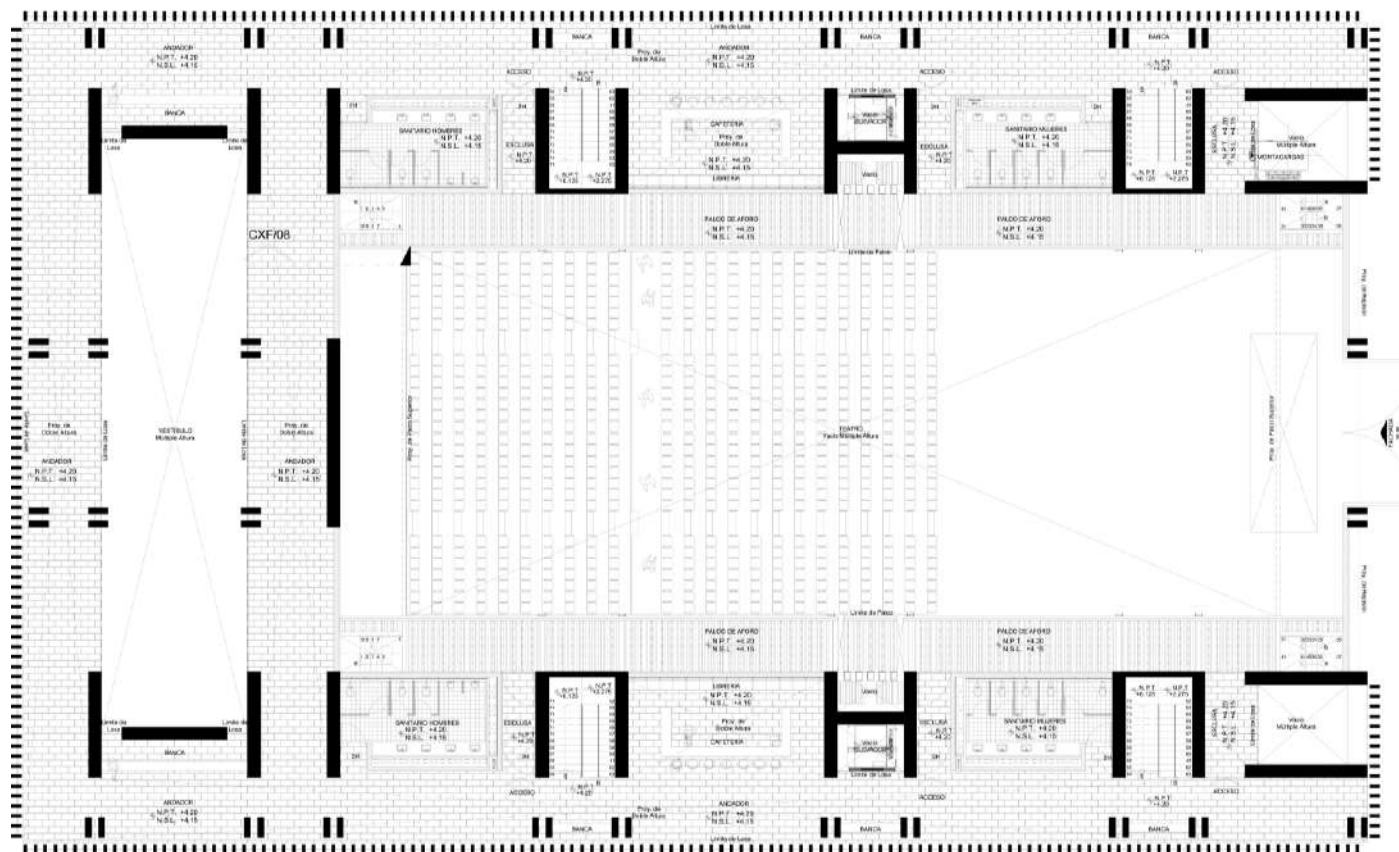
Centro cultural Álvaro Carrillo Nivel o Planta Baja
